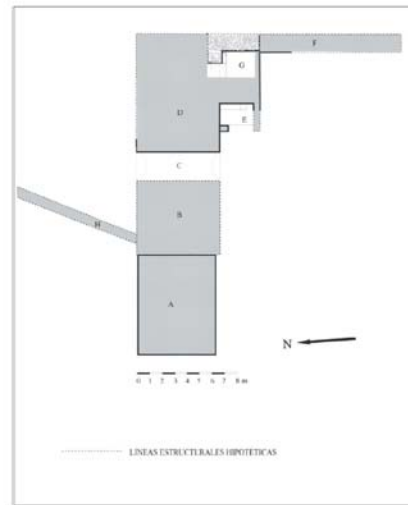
Reconstrucción en planta de la Puerta de Granada.
